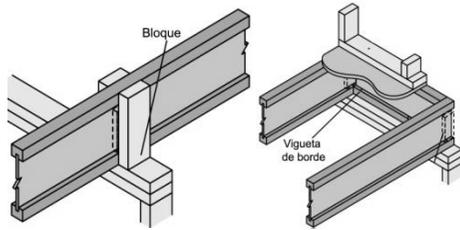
Estructura de vigas, refuerzos vigueta de borde y refuerzo intermedio⁷⁻⁸⁻⁹
